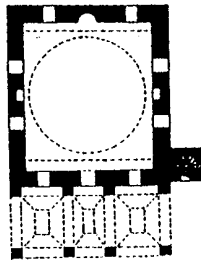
مسقط أفقى لتربة بايزيد يلدريم
